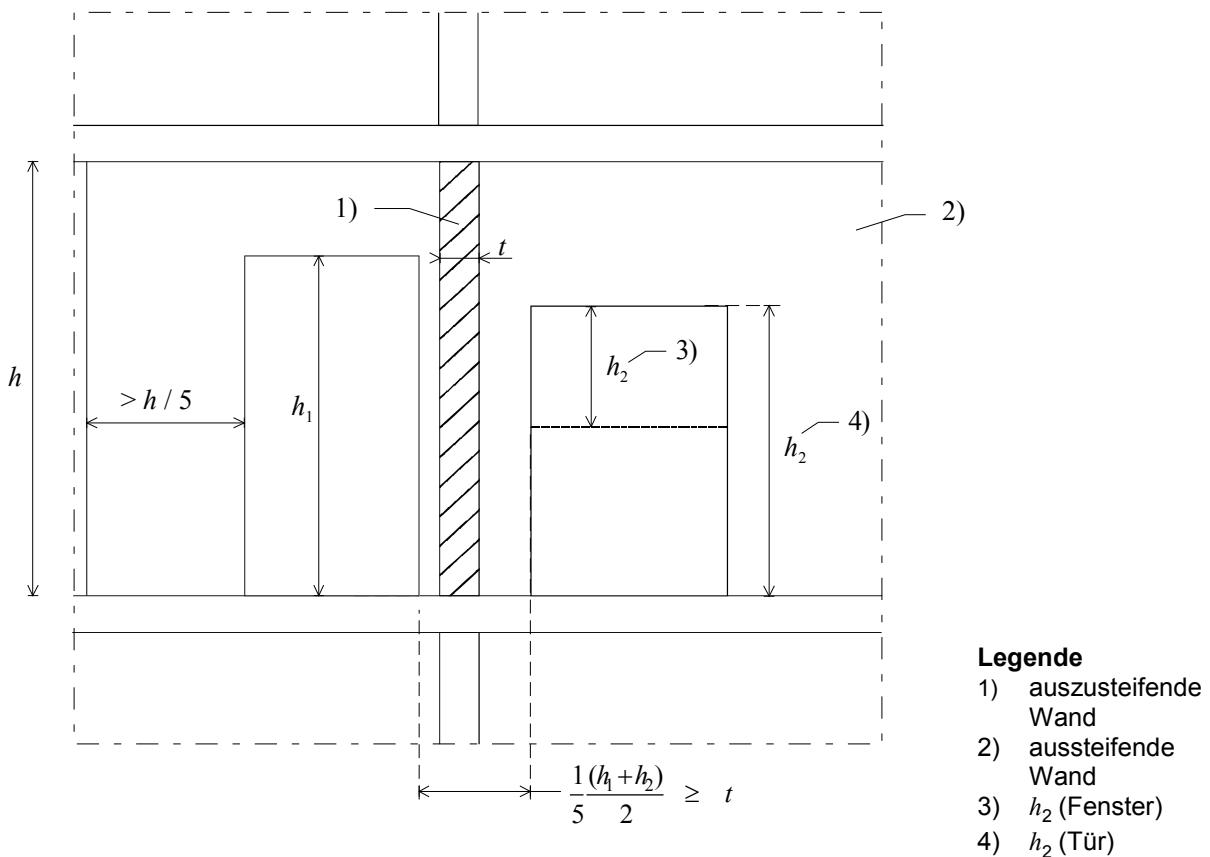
Mindestlänge einer aussteifenden Wand mit Öffnungen
